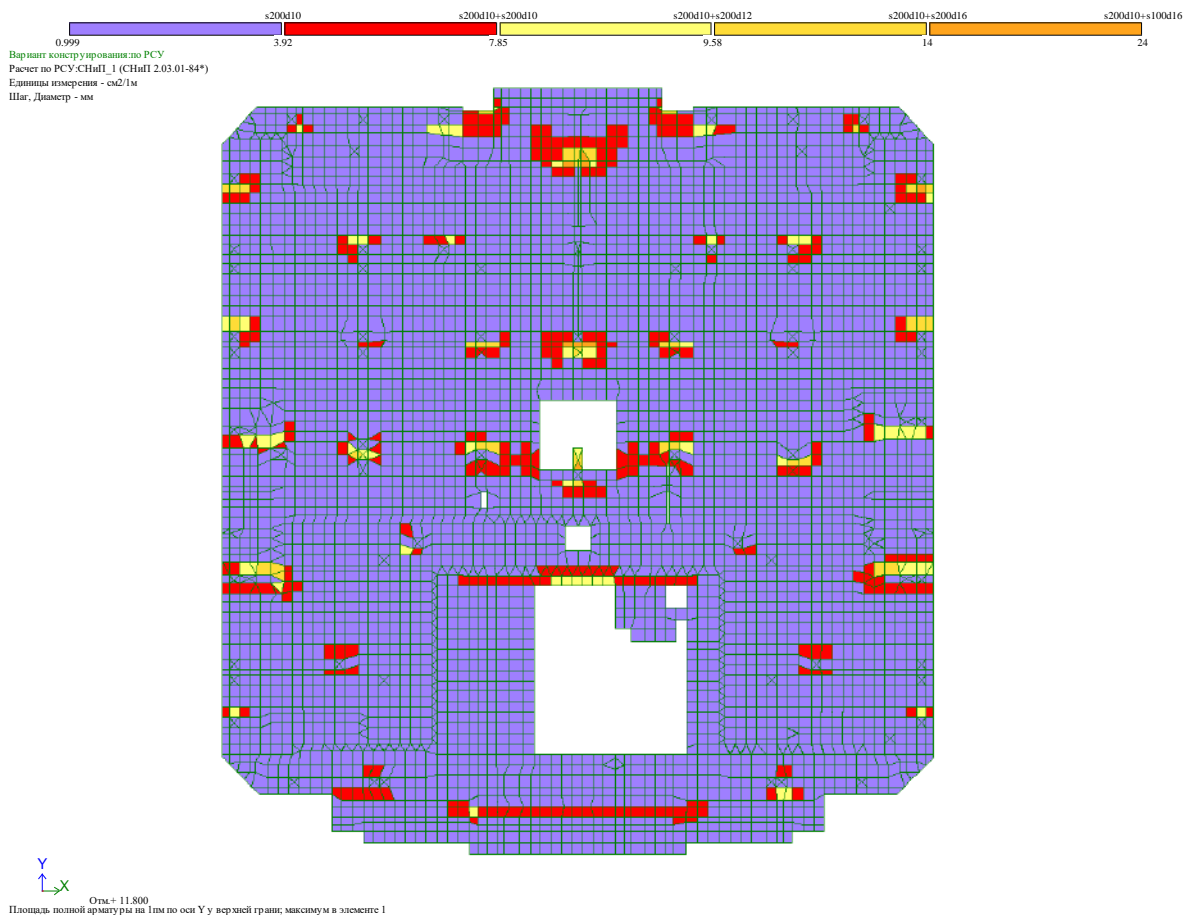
Мозаика армирования верхней арматуры вдоль ц.о.
